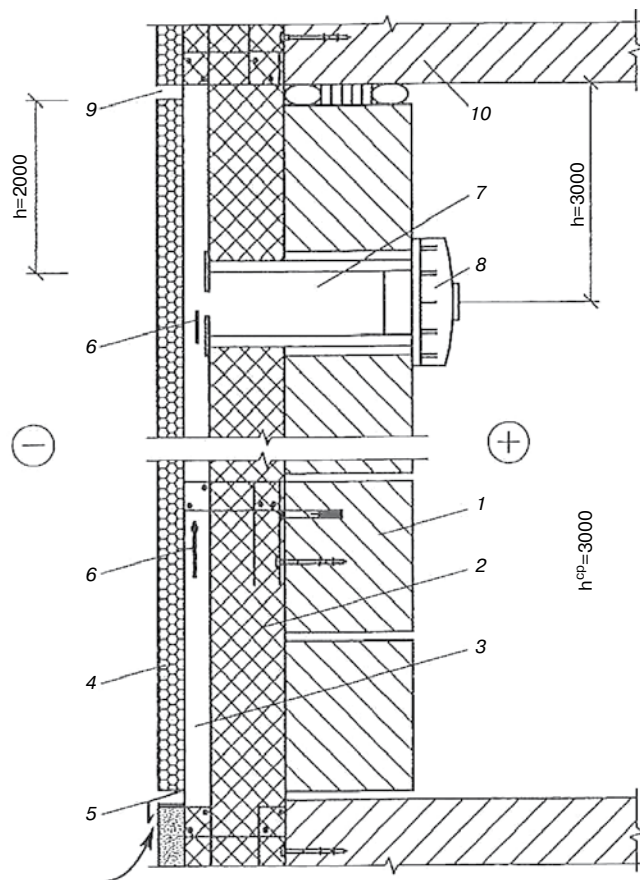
Принципиальная конструкция эффективной наружной стены с организованным воздухообменом: 1 – основание стены; 2 – утеплитель (пенобетон); 3 – вентилируемая прослойка; 4 – экран; 5 – воздухозаборная щель; 6 – движение воздуха; 7 – приточное отверстие; 8 – регулируемый клапан; 9 – воздухоотводящая щель; 10 – междуэтажное перекрытие
